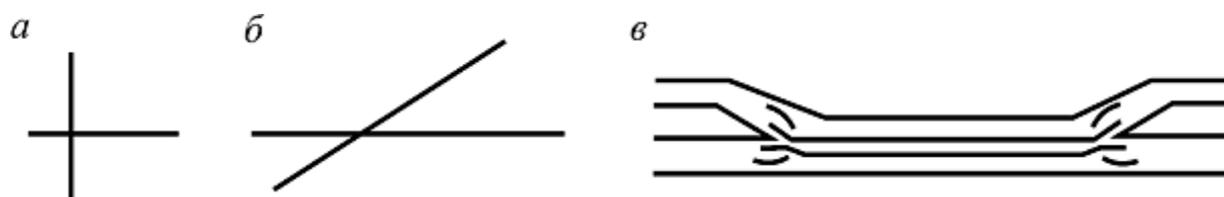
Пересечения железнодорожных путей: а – под прямым углом; б – острым углом; в - сплетение путей
